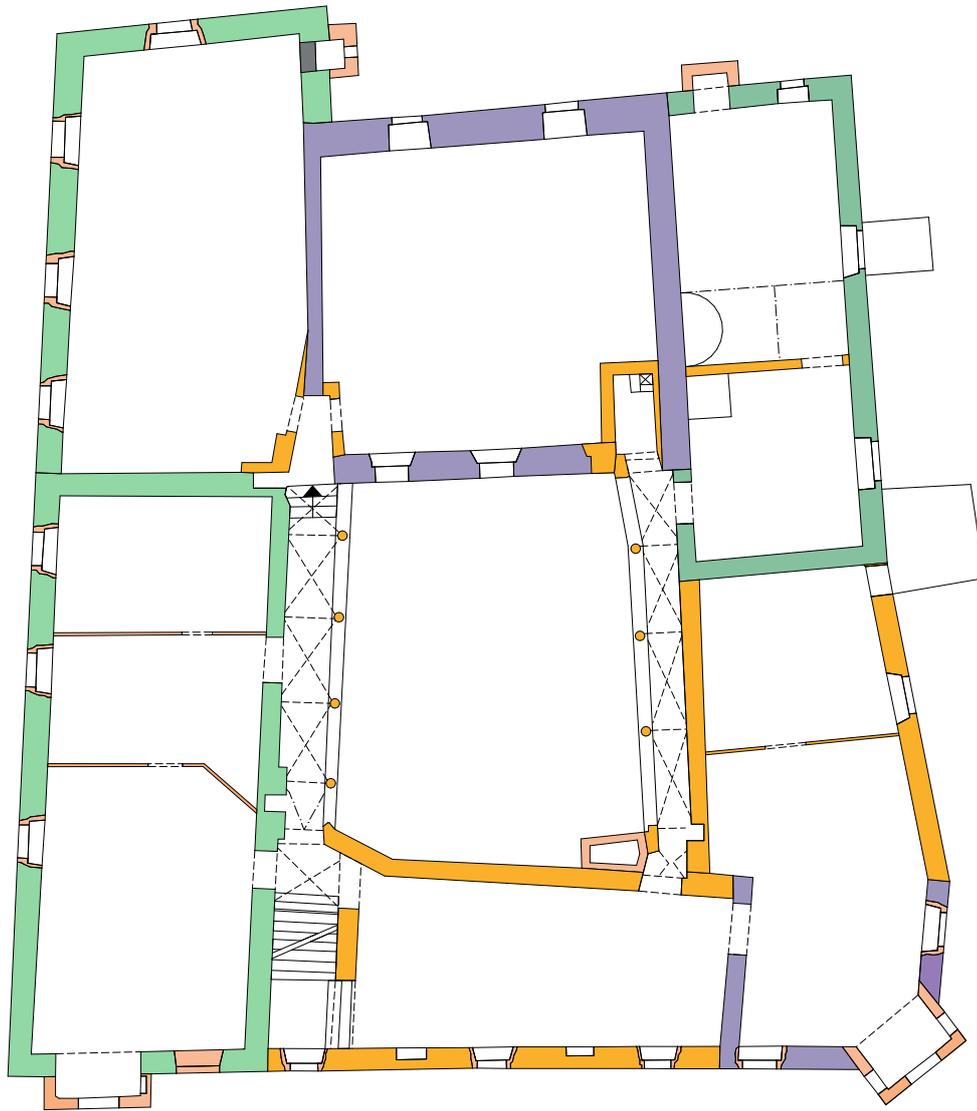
Baualterplan 2. Obergeschoss; M1:200
